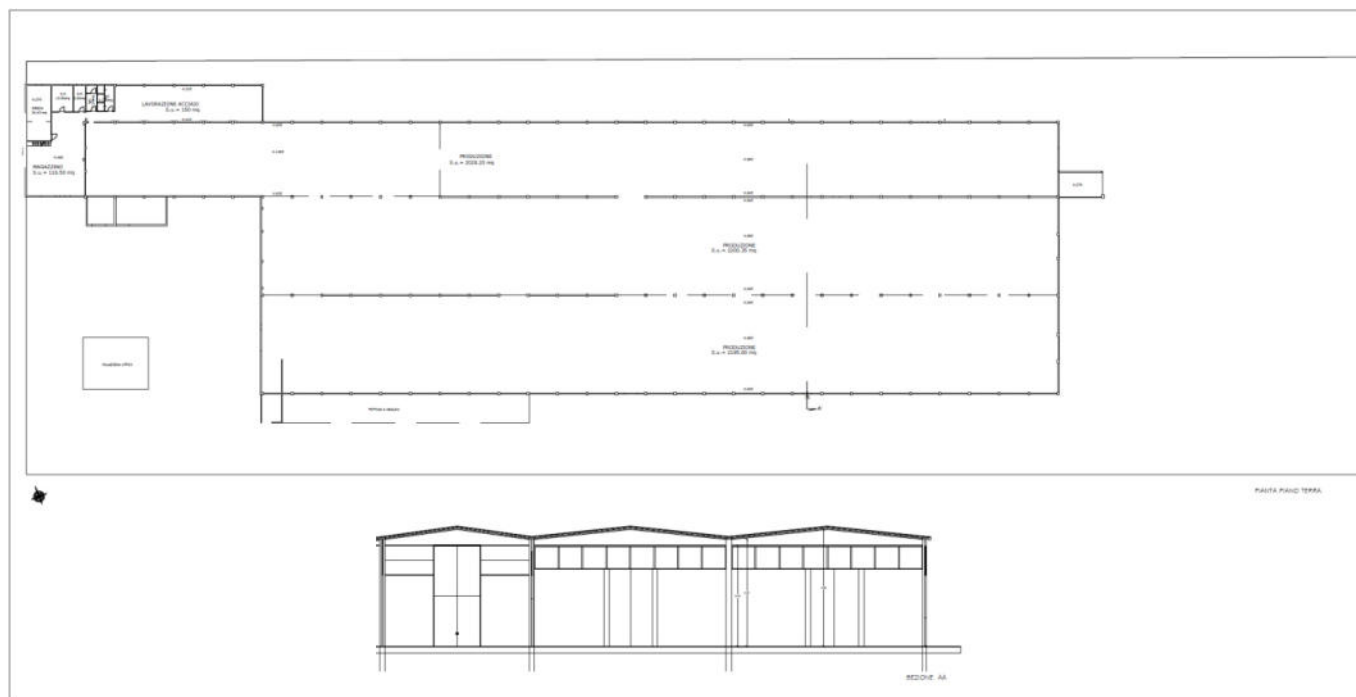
Planimetria e sezione del fabbricato artigianale (fuori scala).
